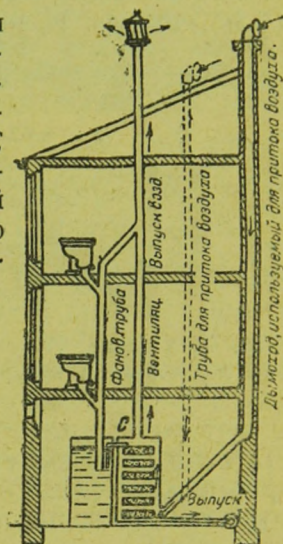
Схема установки для флигеля. Следует обратить внимание на оборудование вентиляции.
